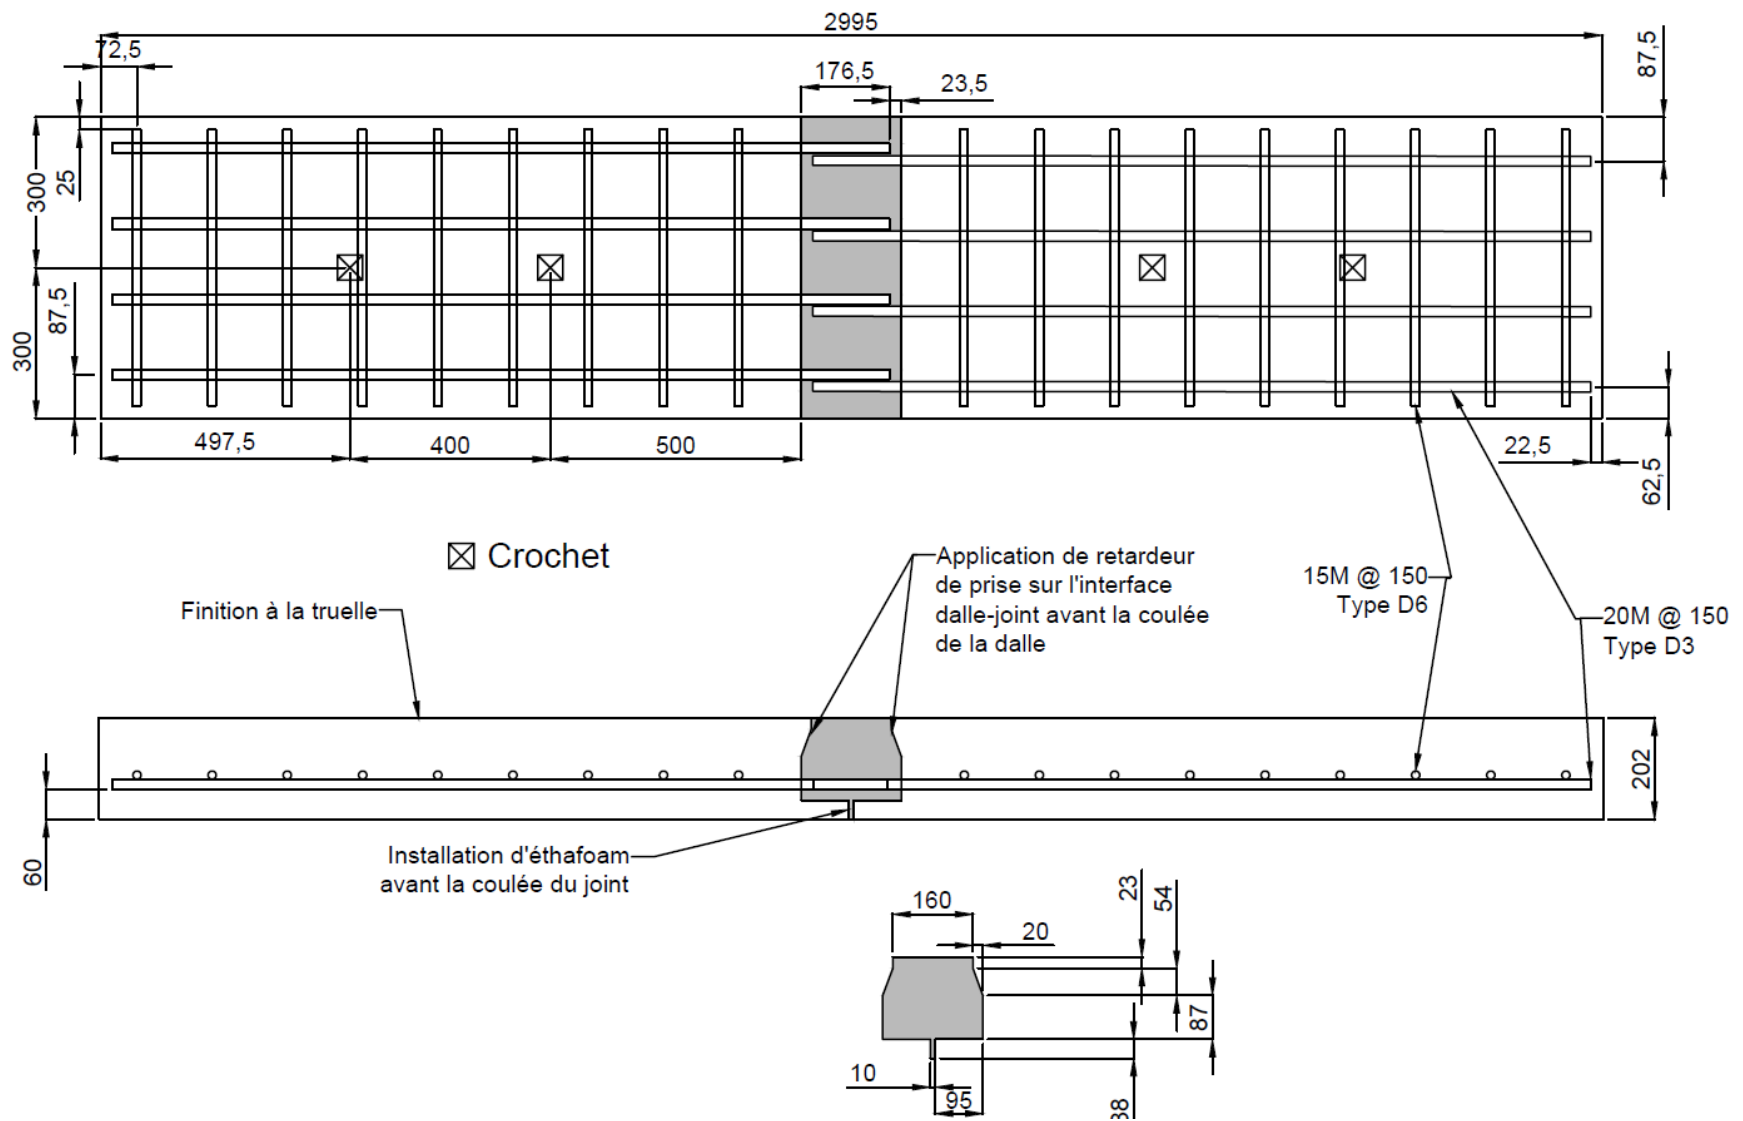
Dalle en BFHP avec joint de connexion longitudinale de 200 mm (TQC) pour le test cyclique (#6)
